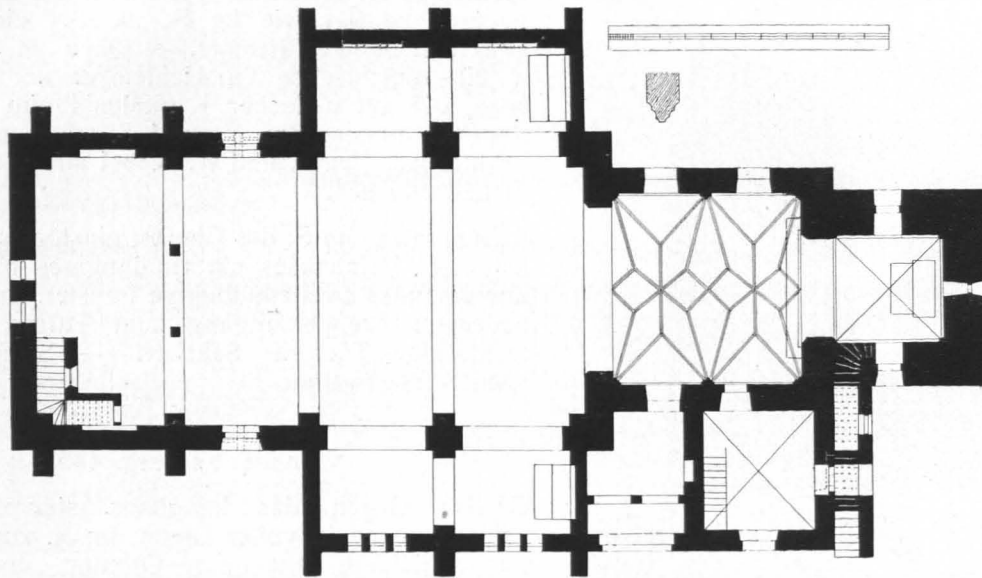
Lamprechtshausen, Pfarrkirche, Grundriß 1:300 (S. 467)
